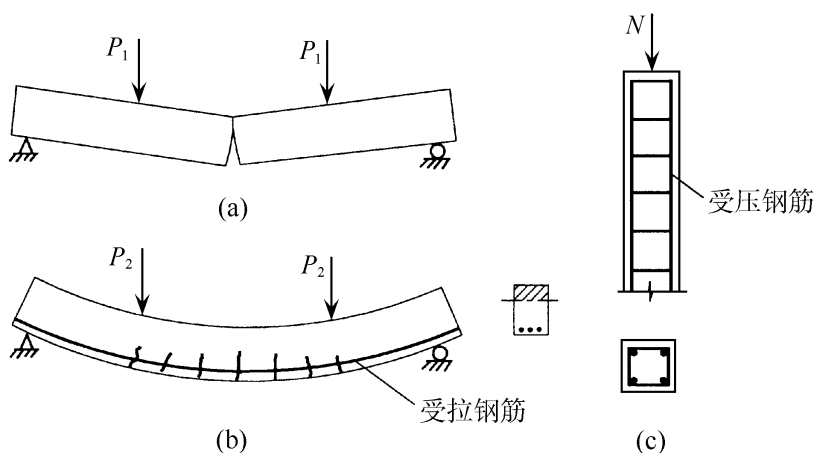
素混凝土梁及钢筋混凝土梁、柱
